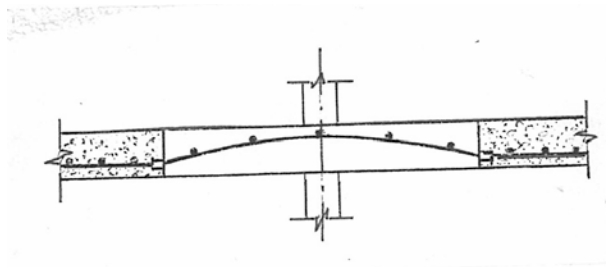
Сборная железобетонная предварительно напряженная капитель, замоноличенная в безбалочное перекрытие.
